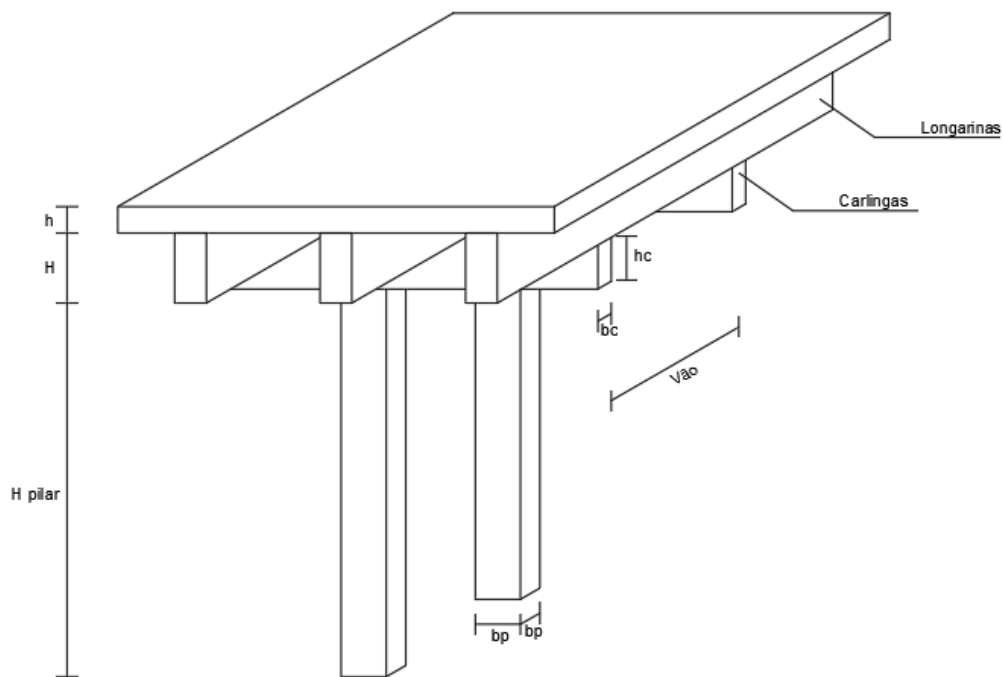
Exemplo 03 - Adição de carlingas e pilares
